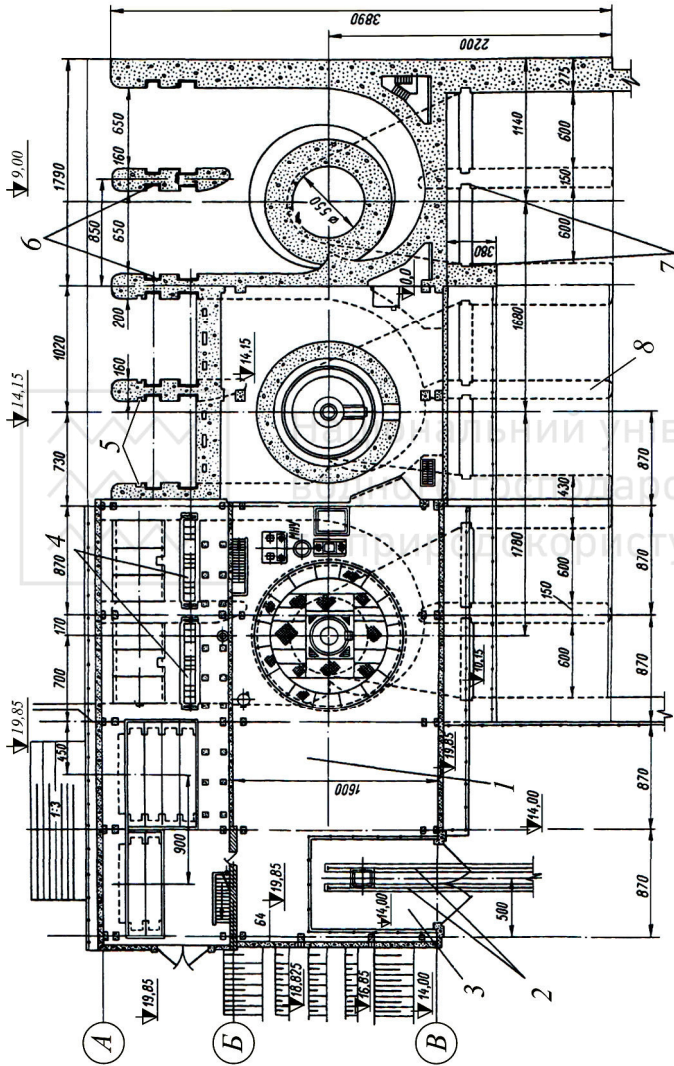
План машинної будівлі ГЕС на різних відмітках:
